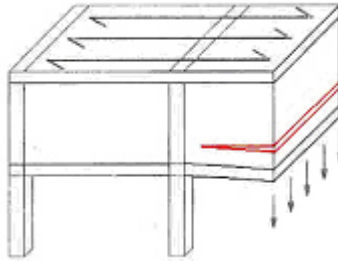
Fisura en voladizo de viguetas.
